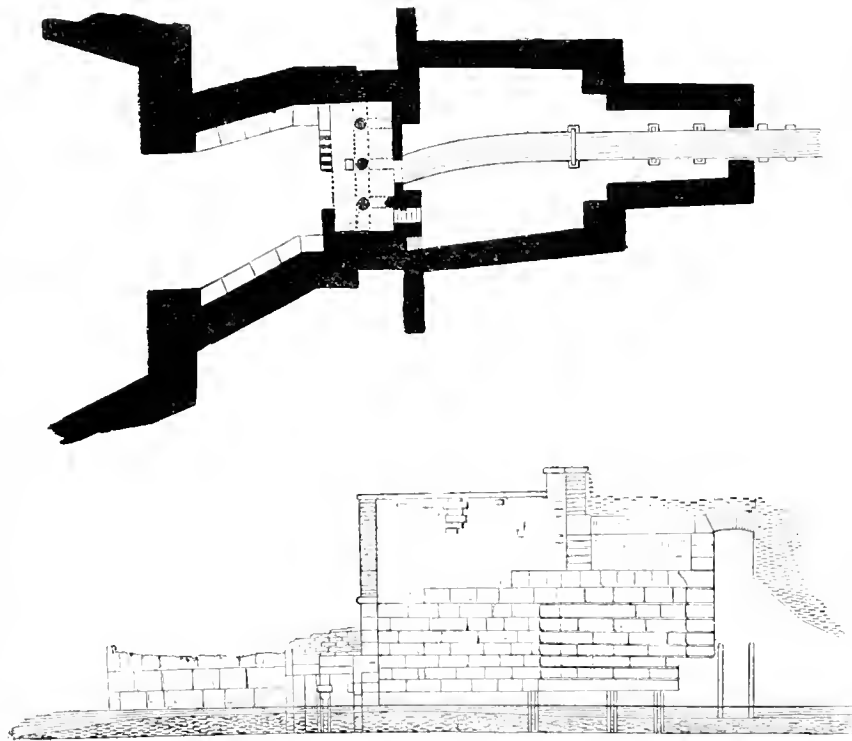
Émissaire du lac d'Albano : plan et section dans la longueur des constructions de la bouche d'entrée.
